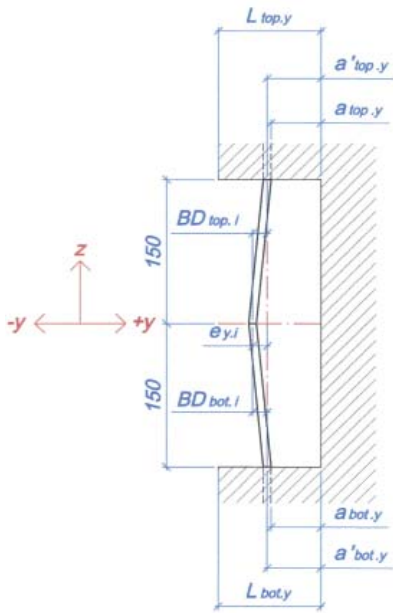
Напрямок відхилень арматурних випусків від осі колон
